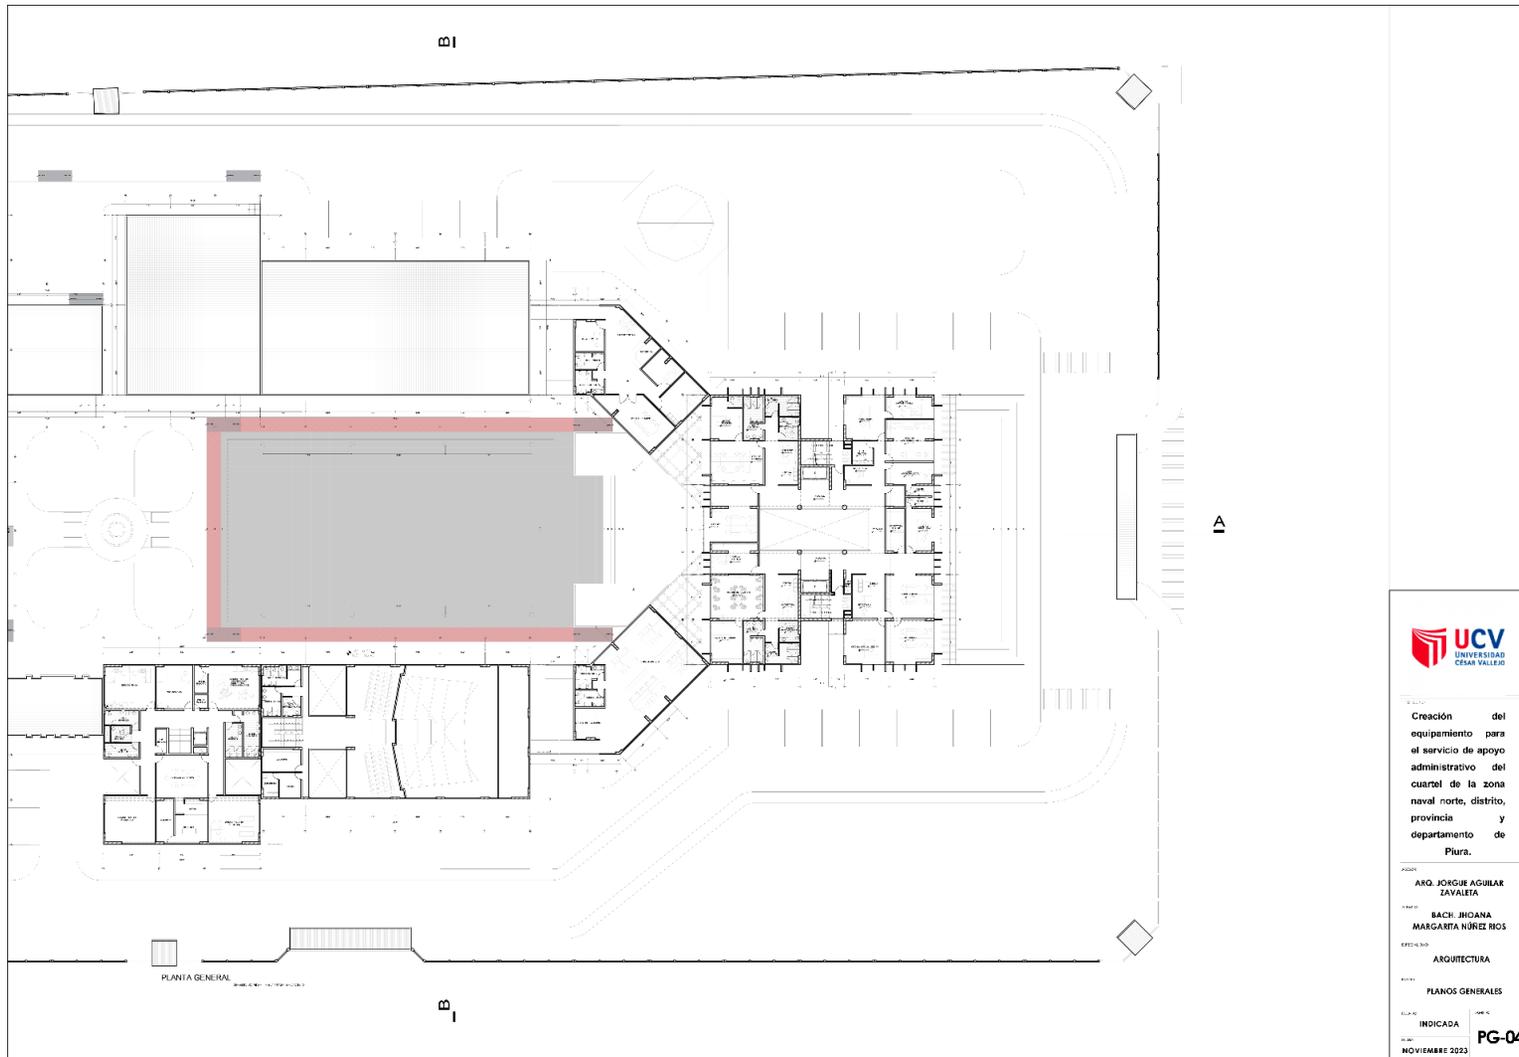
Planos Generales - Plano genera del segundo nivel – SECTOR 2
